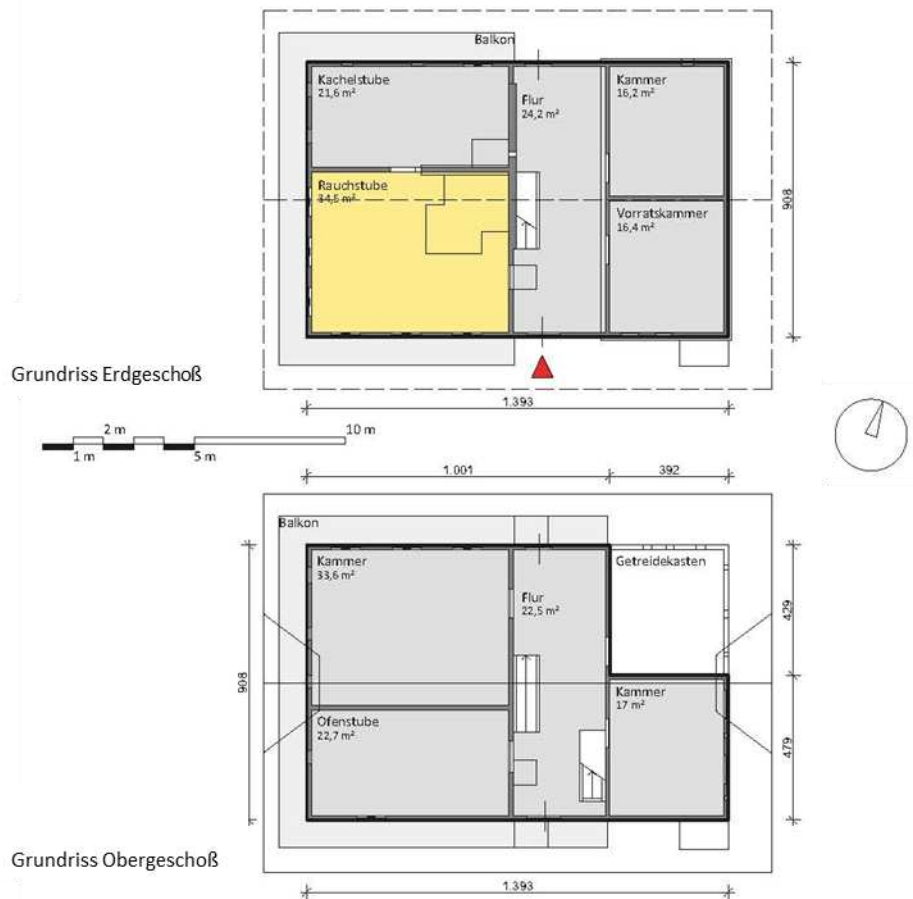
Grundrissdarstellung von Erd- und Obergeschoß des Wohnbereiches
